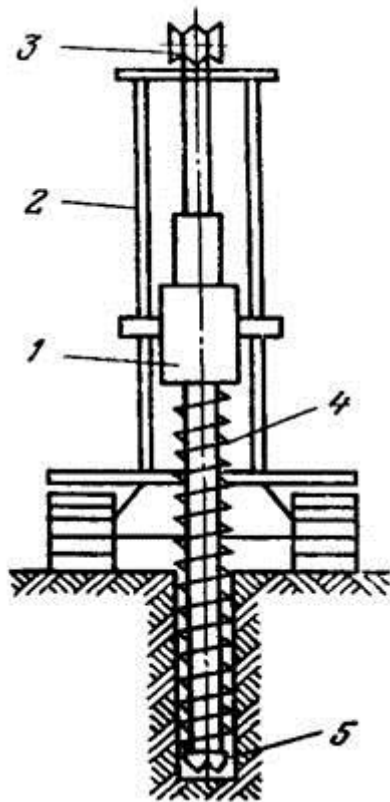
Конструктивна схема верстата обертального буріння різцевими коронками
